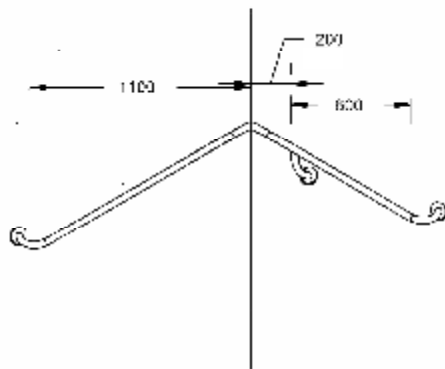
Barras de apoyo. Tipos. (Dimensiones en mm)
